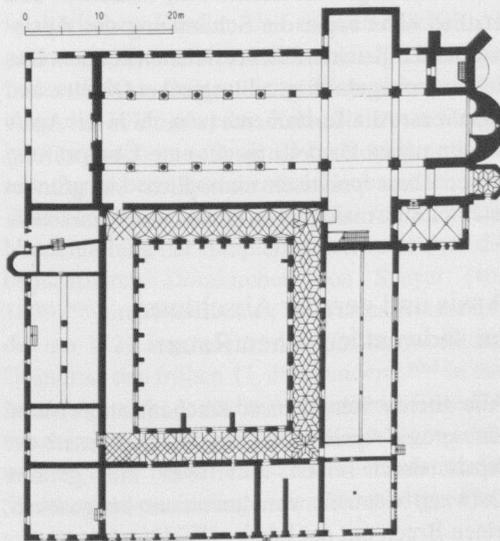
Alpirsbach, Hl. Dreifaltigkeit, Hl. Kreuz und St. Benedikt. Grundriss (nach Dehio Baden-Württemberg). M. 1:1000.
